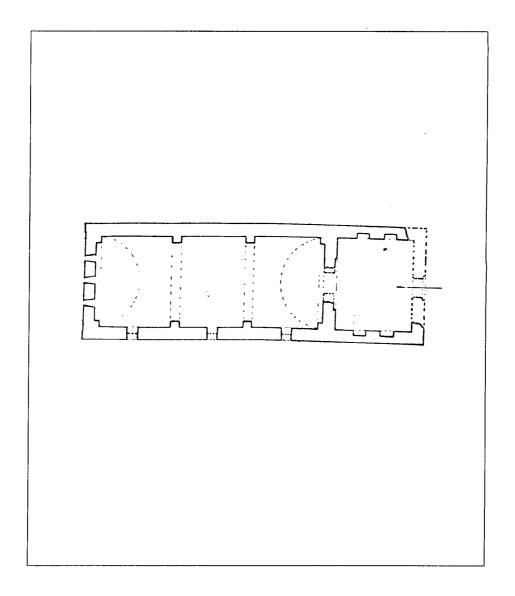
مسقط أفقي وقطاع لخان قير شنلو في فيلبه ببلغاريا (عن : كيل) .
